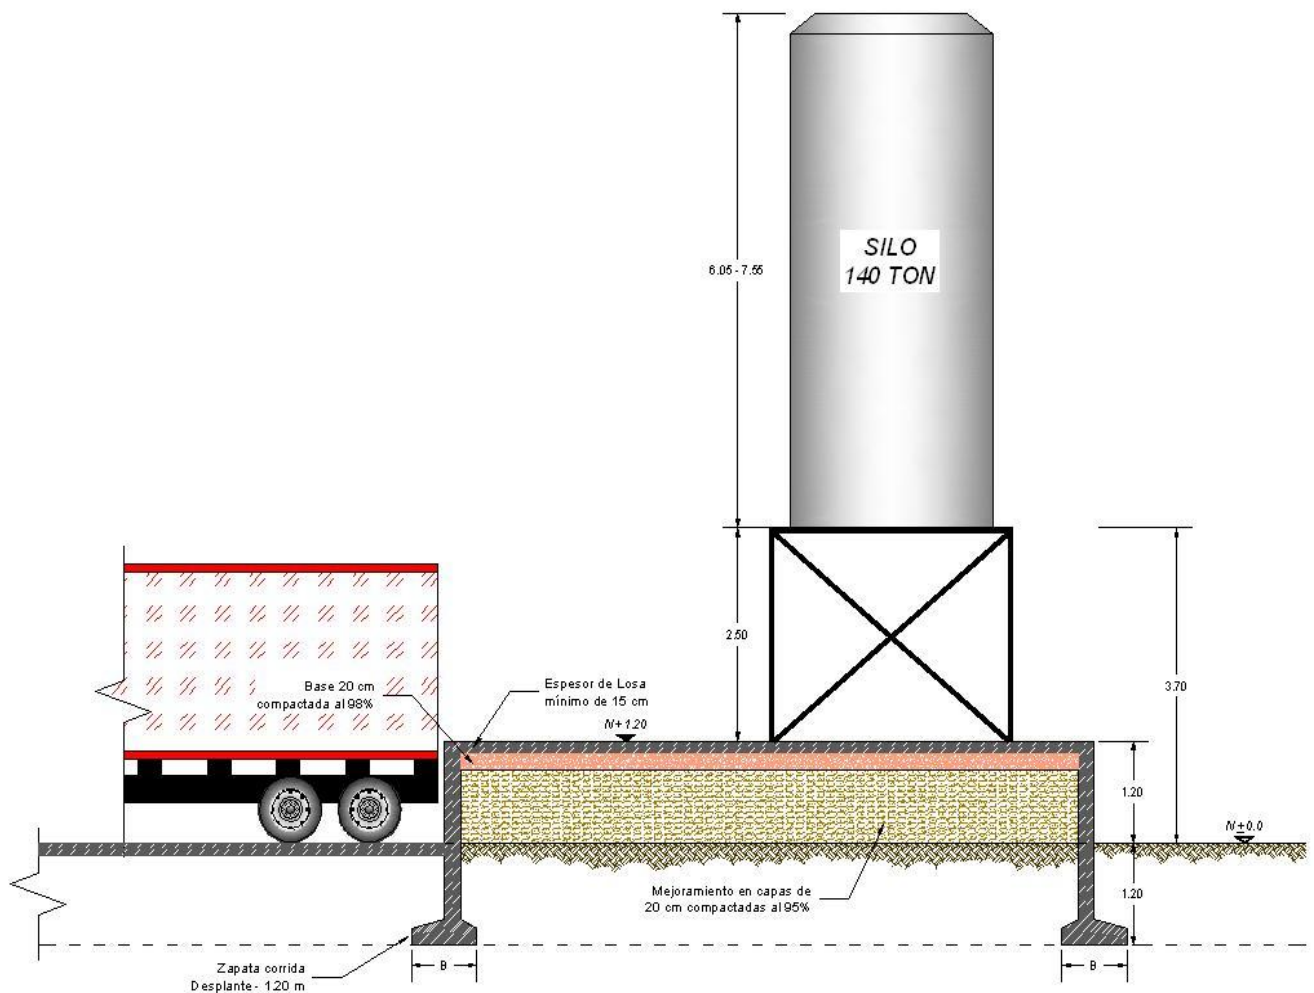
CIMENTACIÓN BODEGA DE ENSACADO
